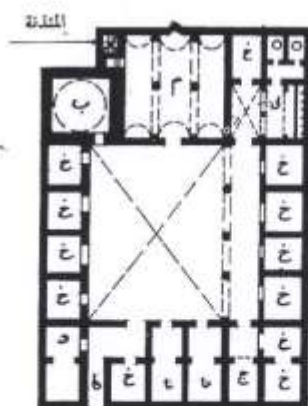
المسقط الأفقي لزاوية مسجد أحمد البزاز بزليطن
